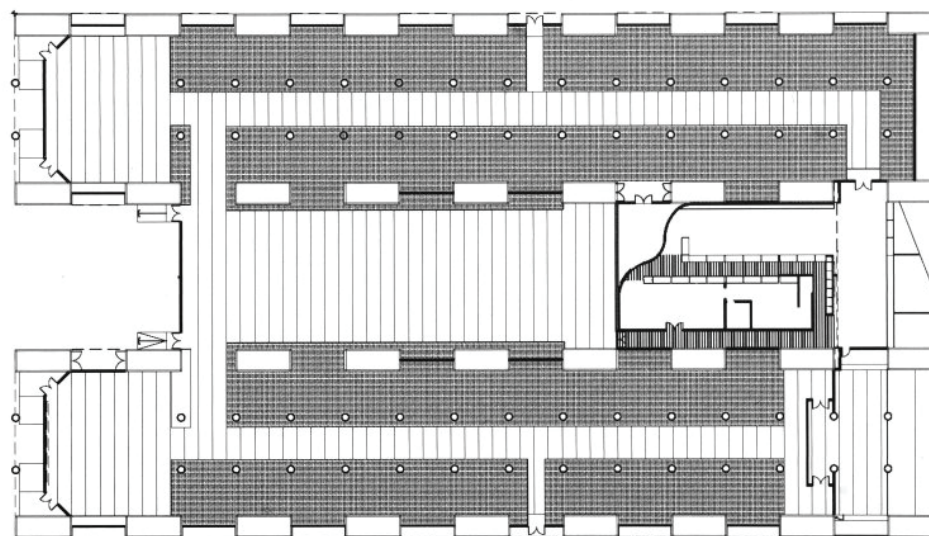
Pianta piano terra, museo di Santa Monica; Fonte: <https://www.lib.ncsu.edu/>;
